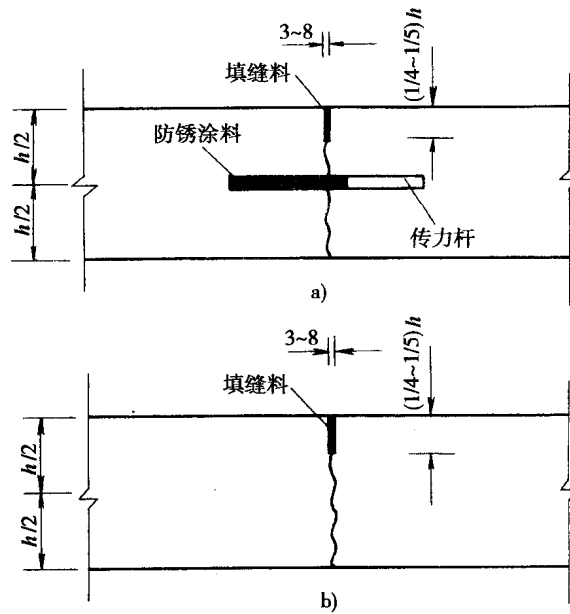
横向缩缝构造(尺寸单位:mm)
